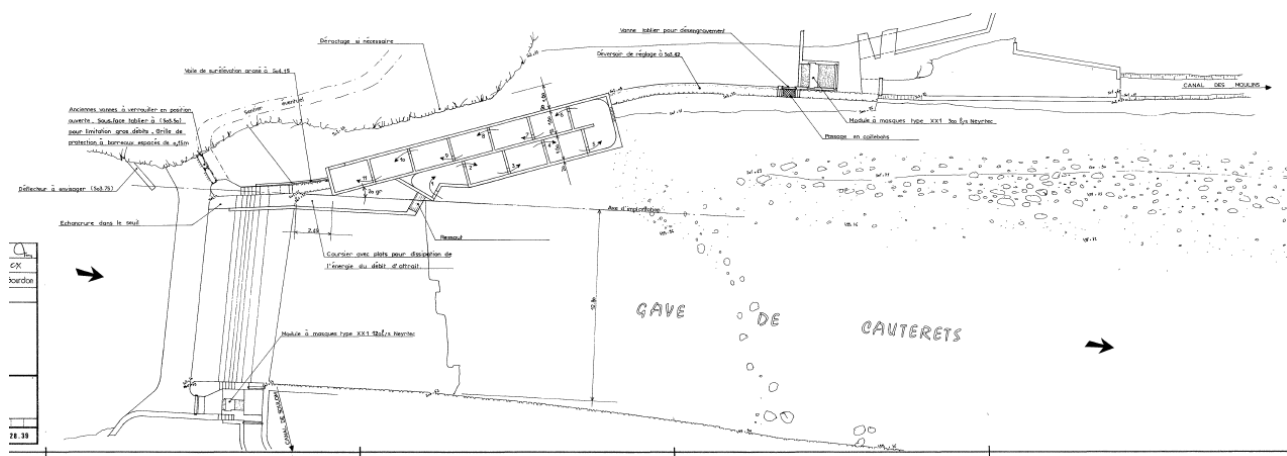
plan des ouvrages de prise d'eau (SHEM)
